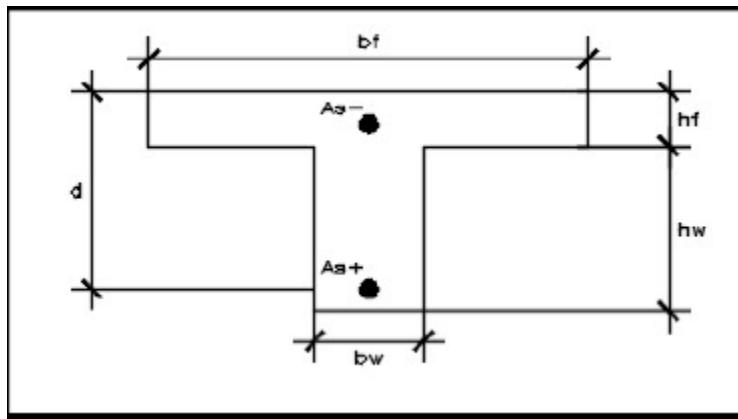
Dimensiones de la viga típica de la losa aligerada
